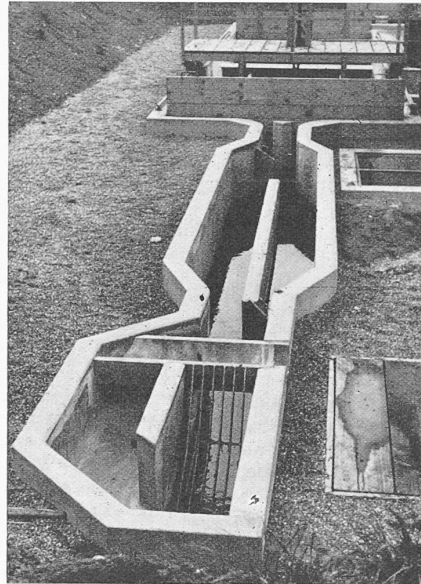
Rechen mit Umlauf, Sandfang und Absitzbecken (vgl. untenstehenden Grundriss Abb. 3)
